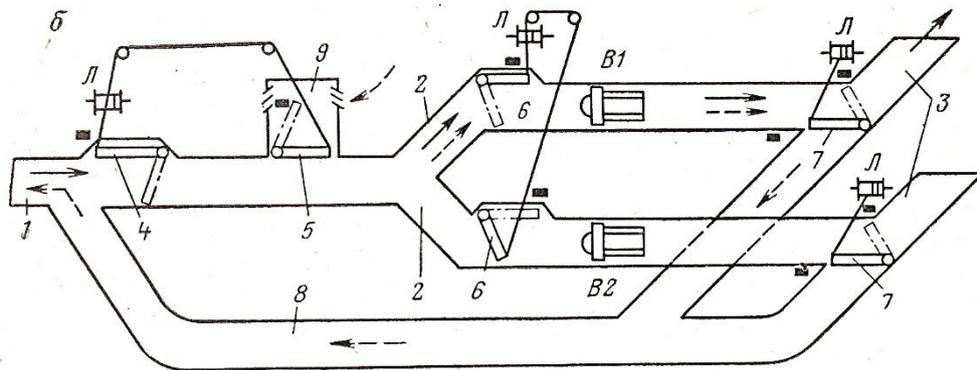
Схема вентиляторной установки с двумя осевыми вентиляторами
